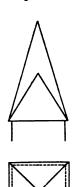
u. 39. Turmdach. Abb. 38. Ansicht.
